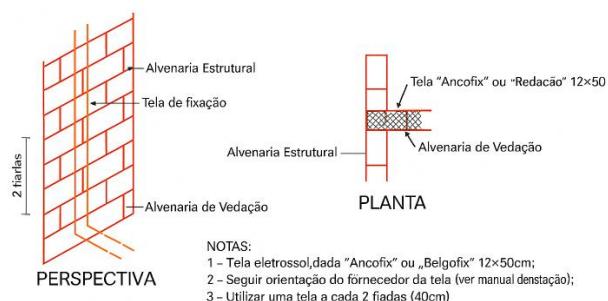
Detalhe das telas de fixação alvenaria estrutral + vedação (Fonte: TECOL projetos)
